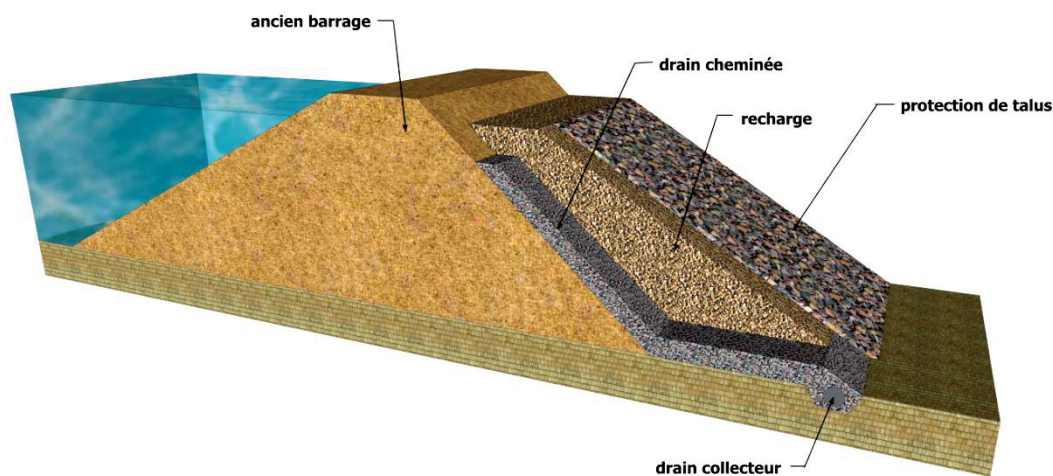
Simple section montre le drain cheminée ajouté à un barrage existant.
